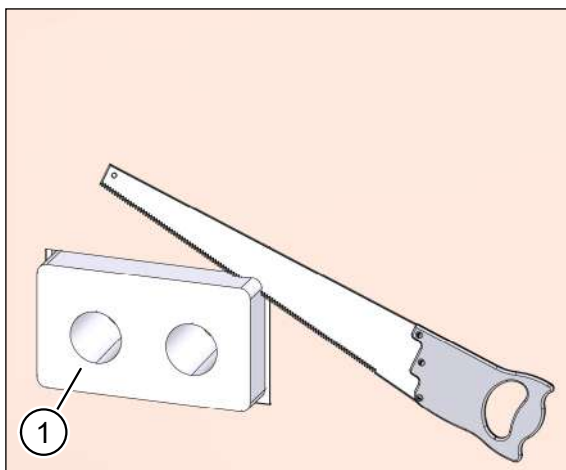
Modifica della cassetta a muro senza elemento di riempimento
